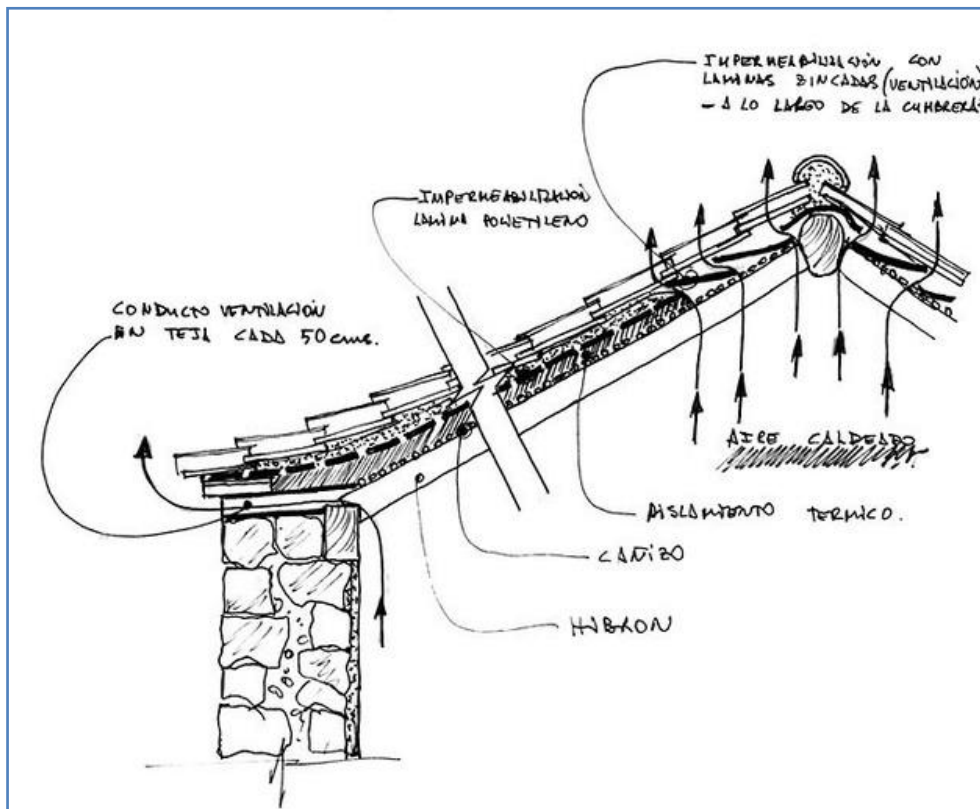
Esquema cubierta teja árabe sobre cañizo.
